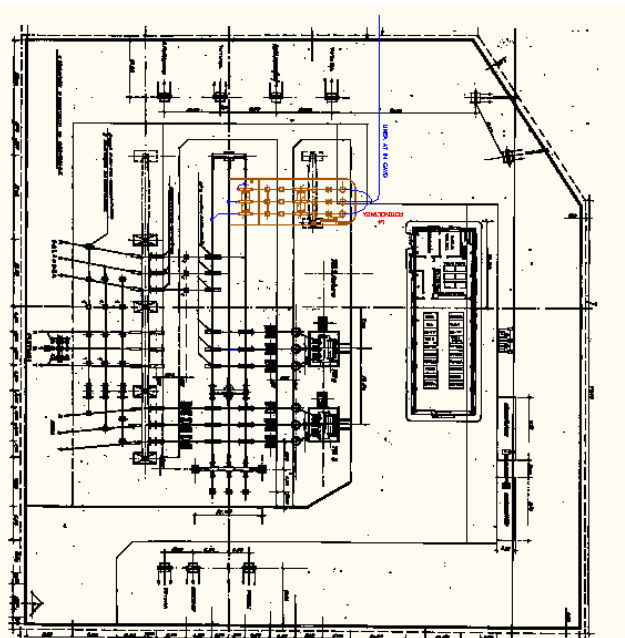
Planimetria generale elettromeccanica - stato di progetto
